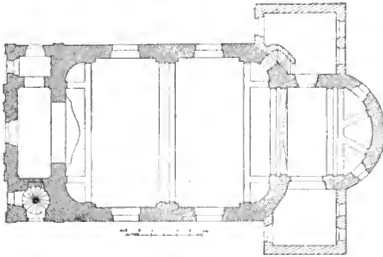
Dobruška. Grundriss der Pfarrkirche.
